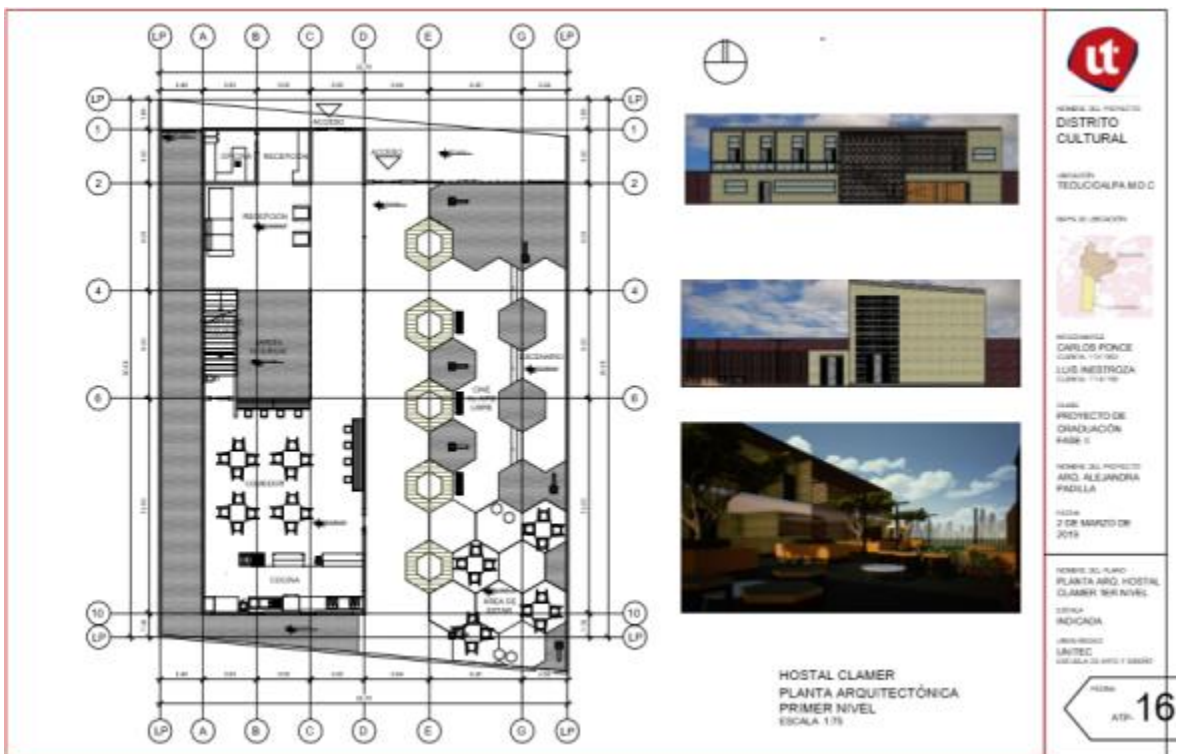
Planta Arquitectónica Hostal Clámer Primer Nivel
